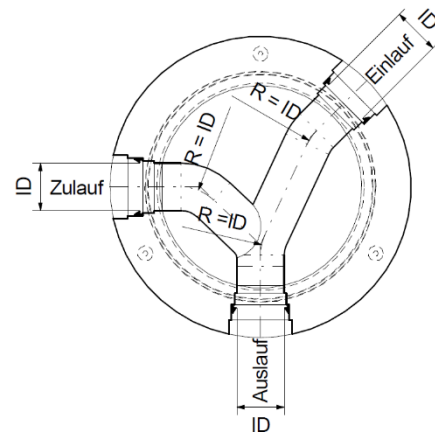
CENTUB® Massschachtunterteil Einlauf und Zulauf Typ 2
